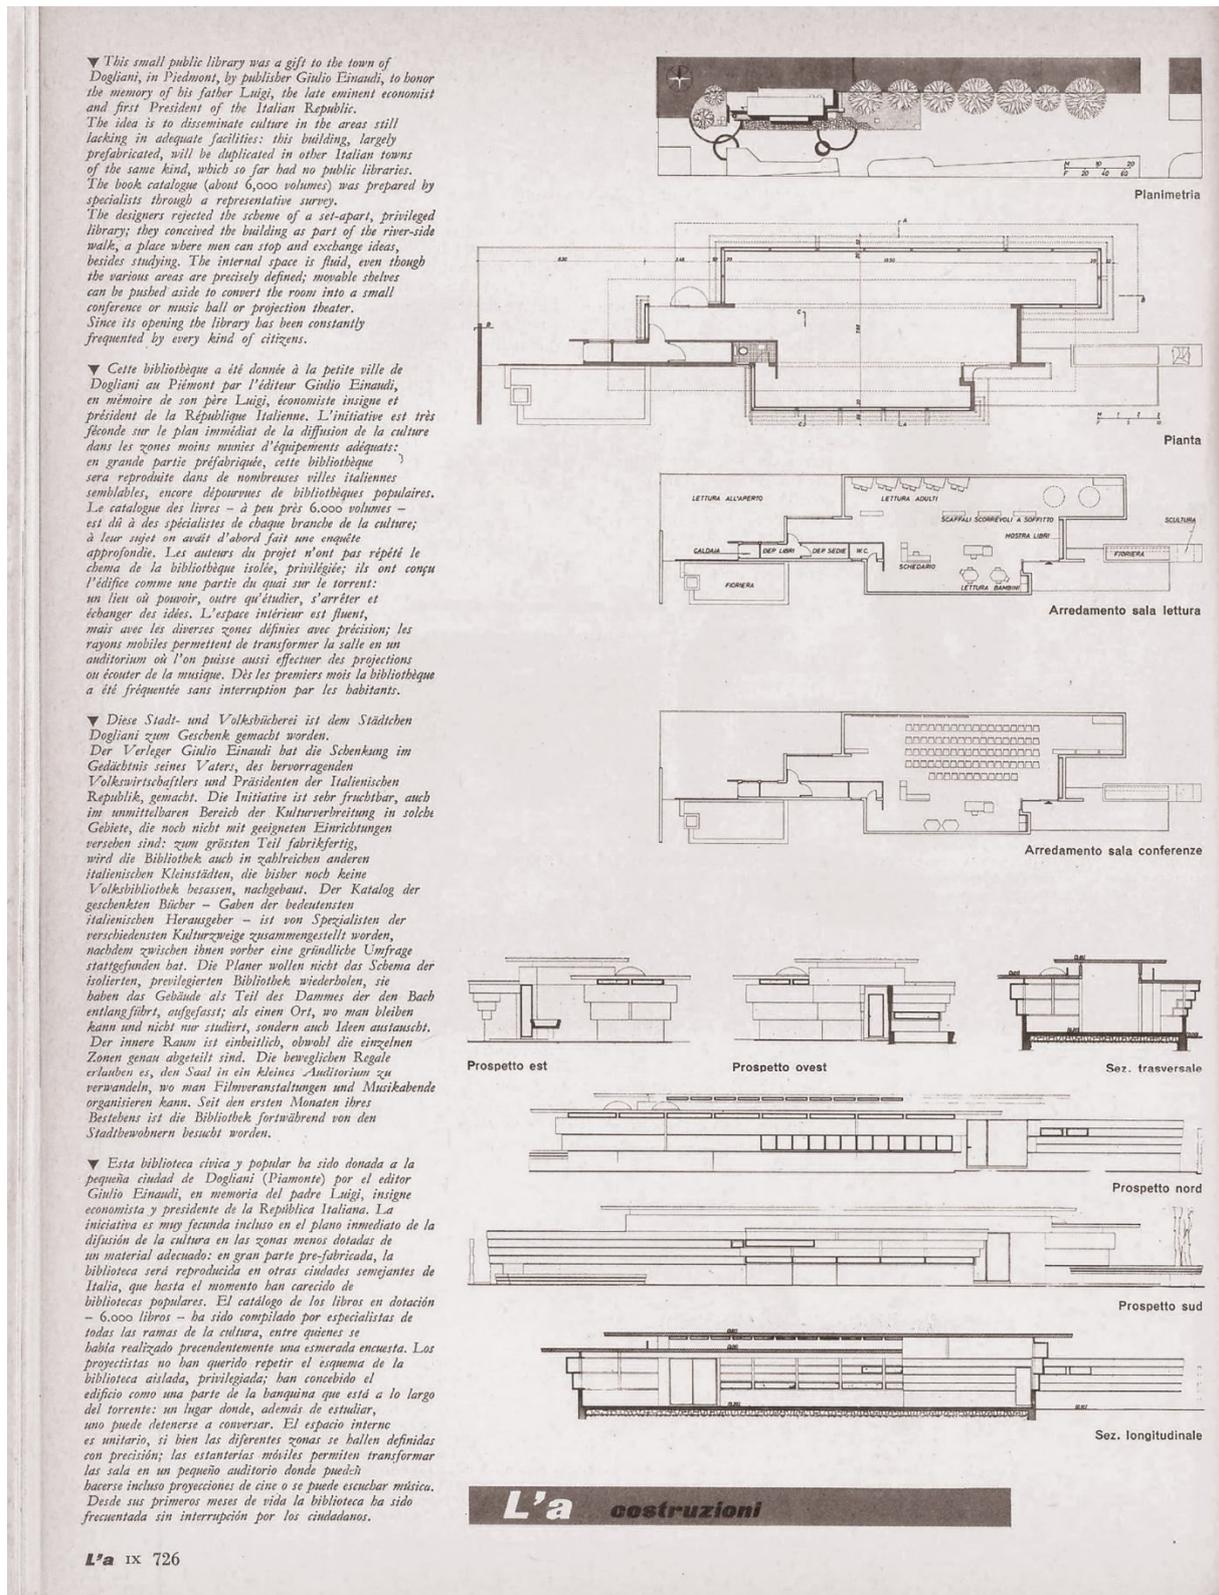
B. Zevi e Studio A/Z, Biblioteca Luigi Einaudi, Dogliani, 1963. Planimetria, piante delle due diverse configurazioni, prospetti e sezioni (L'architettura cronache e storia 1964, 726).
